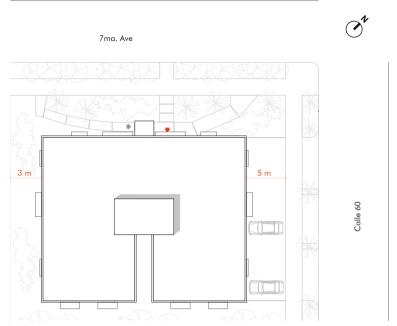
Planta de Implantación: edificio de Evangelina Aristigueta de Vidaña. 1956.
